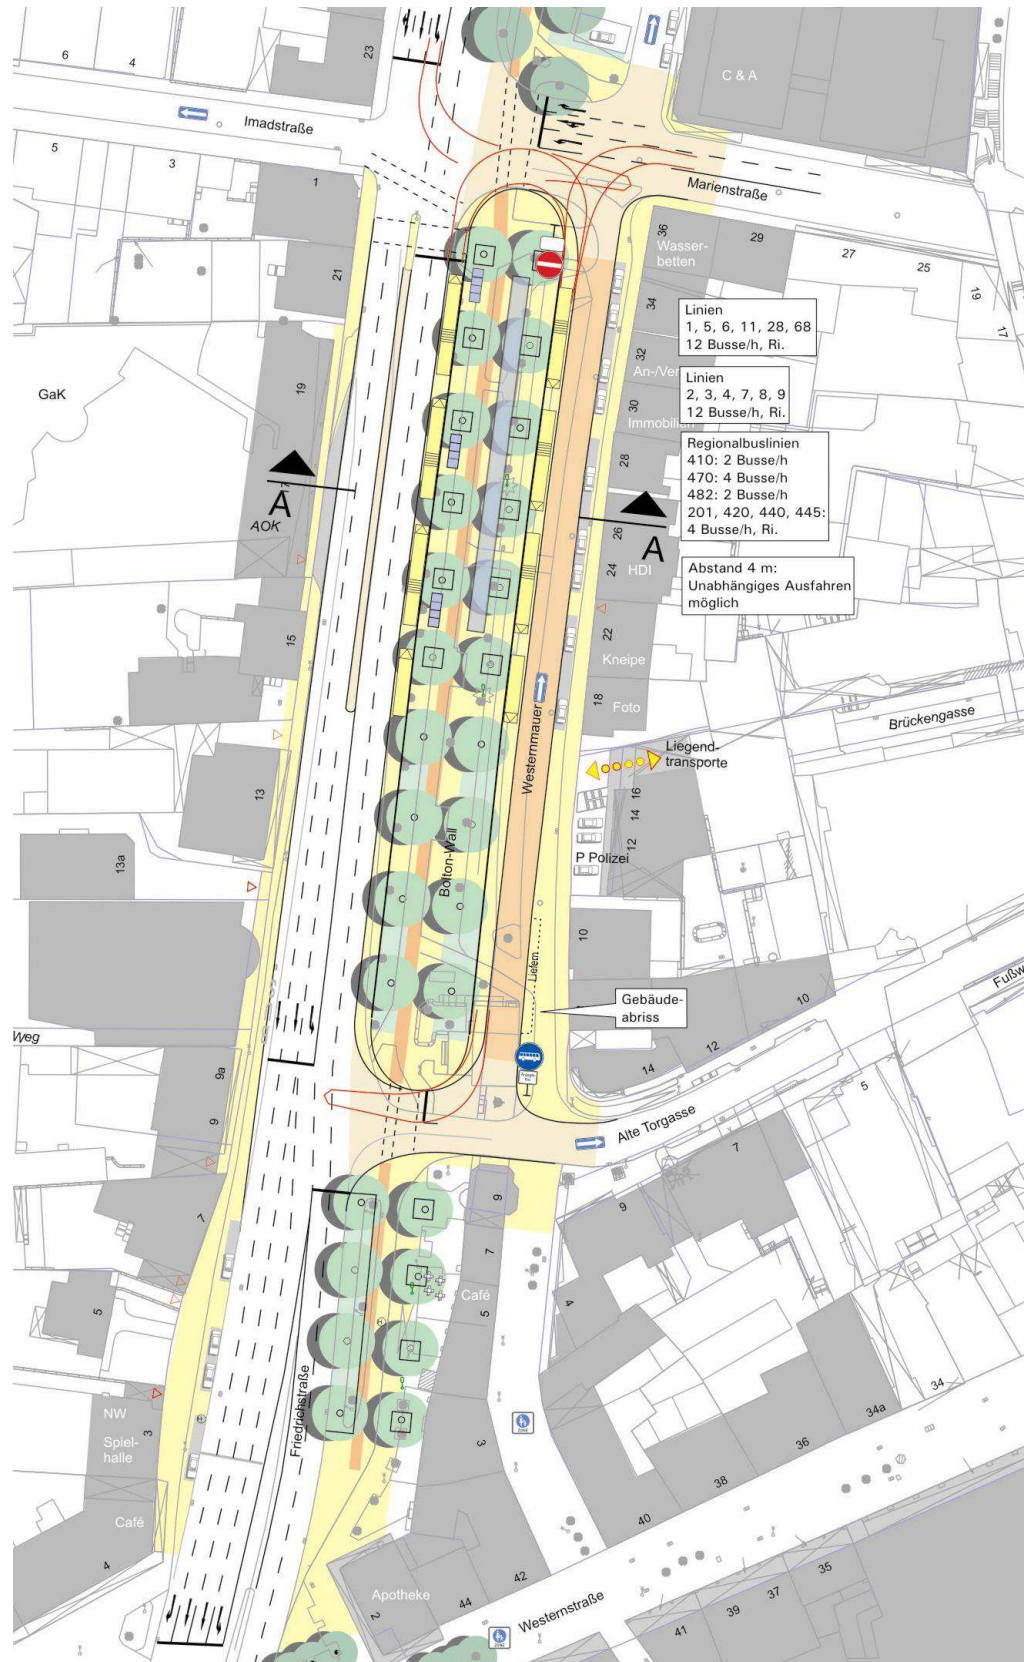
Variante 2 (Wallbereich als Bushalteinsel) der ZOH Westermäuer im Lageplan
